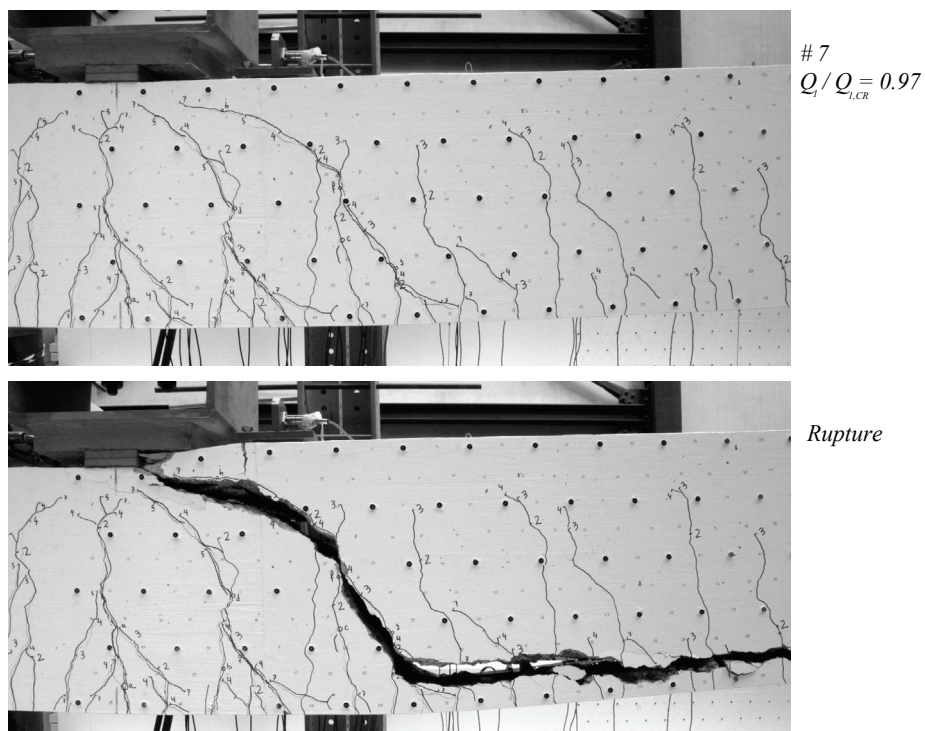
Poutre SR4: Fissuration avant rupture en travée (palier 7) et après rupture
